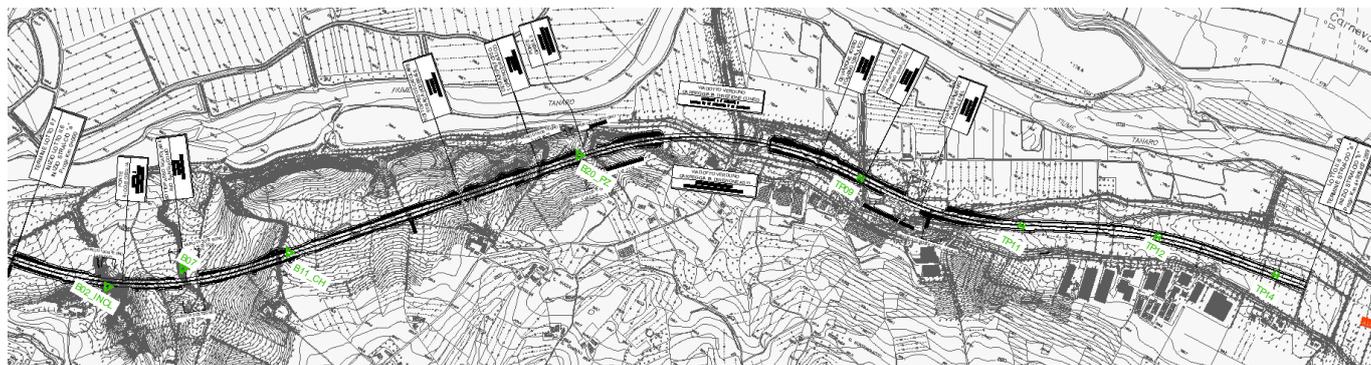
Stralcio Planimetria di ubicazione dei campioni di caratterizzazione ambientale
